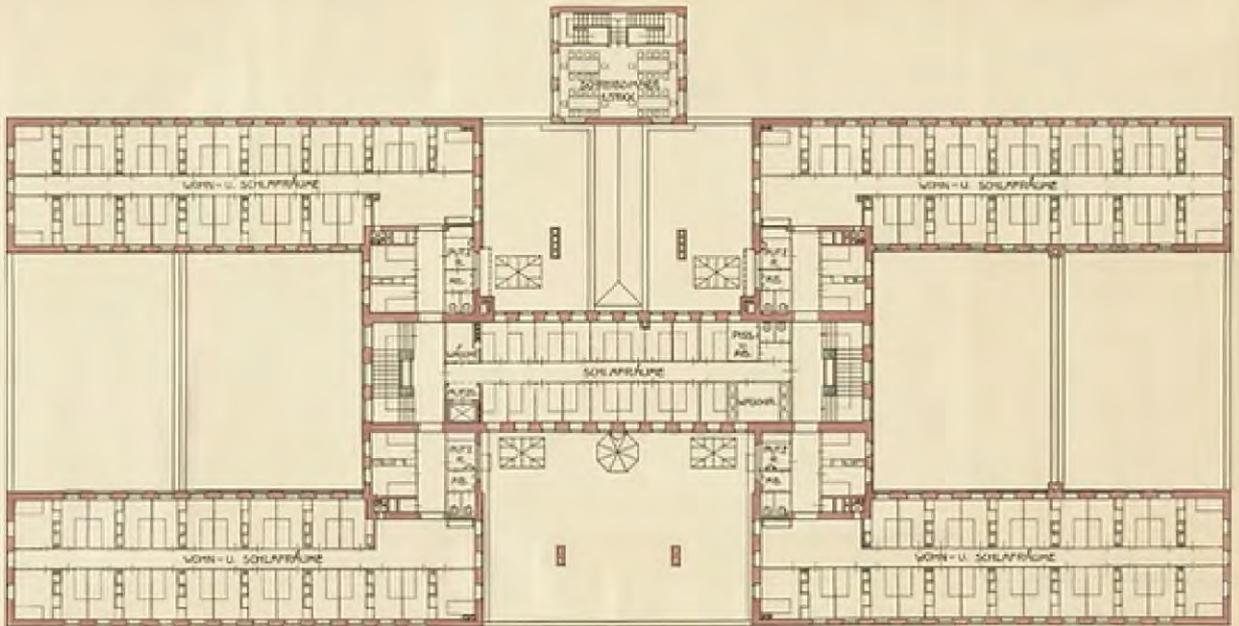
Ledigenheim, München, Theodor Fischer, 1926-27, Grundriss des 1., 2. und 3. Obergeschosses M1|500
